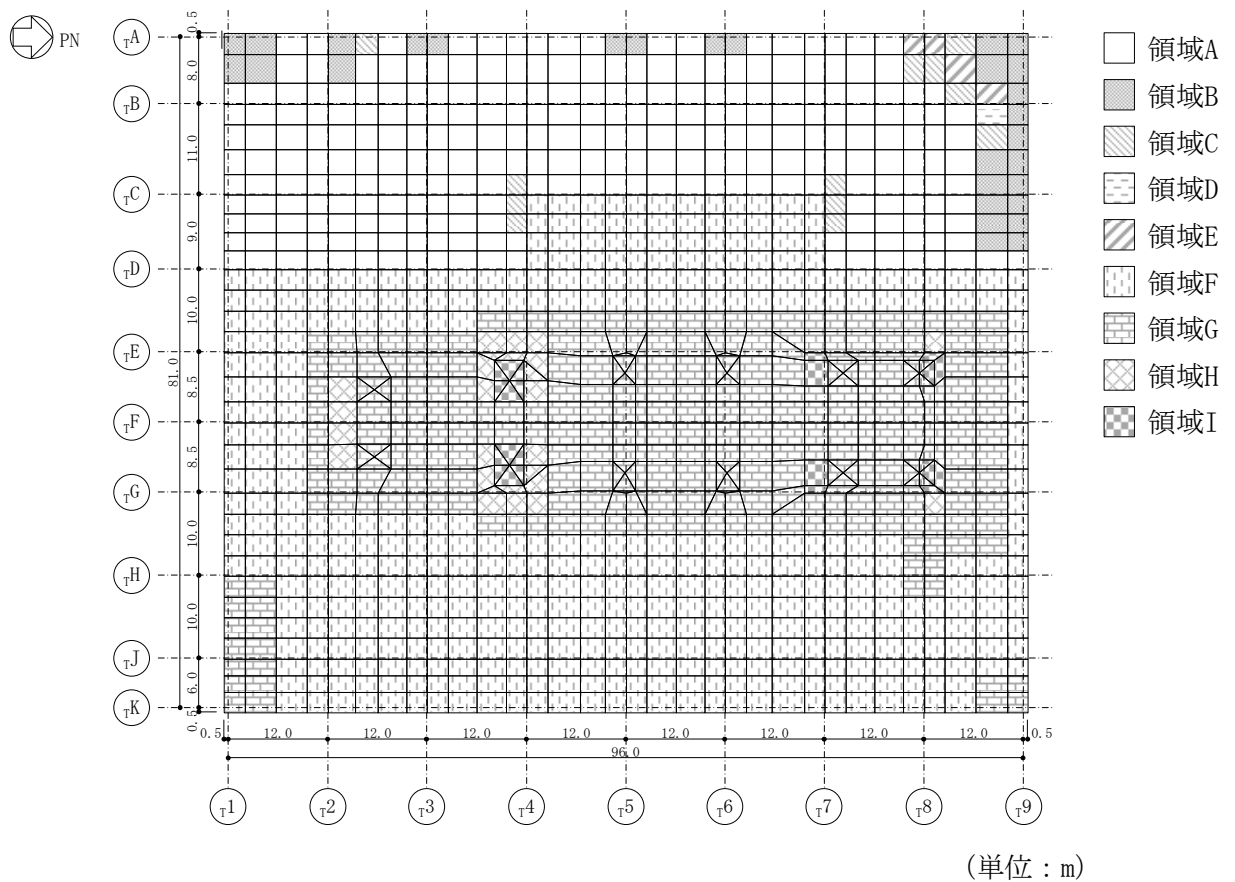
基礎スラブの配筋領域図 (NS 方向, 下ば筋)
